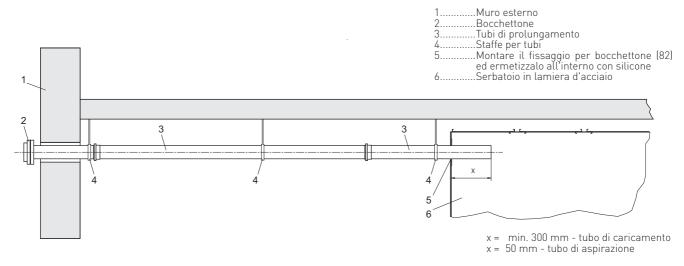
Bocchettone con tubo di prolungamento e serbatoio in lamiera d'acciaio – vista laterale
